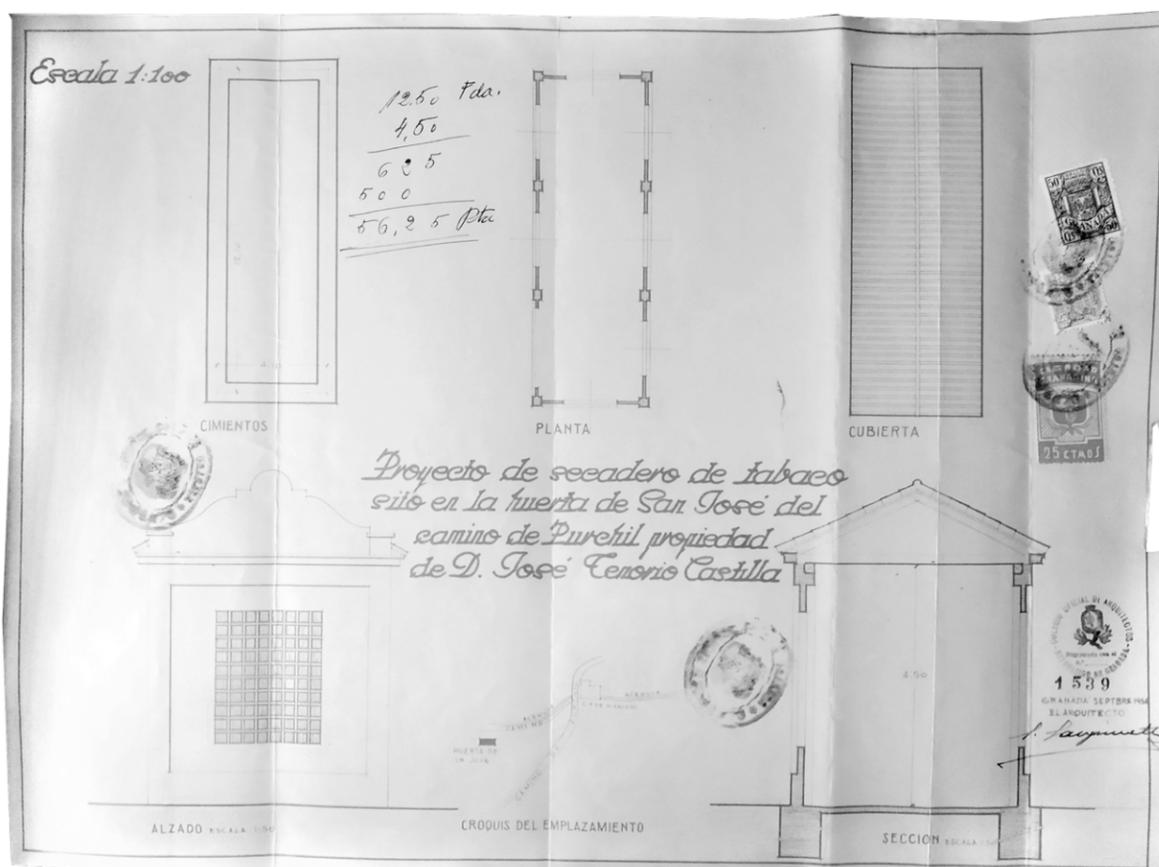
Planos del secadero (1954). SANGUINETTI LOBATO, S. Arquitecto
